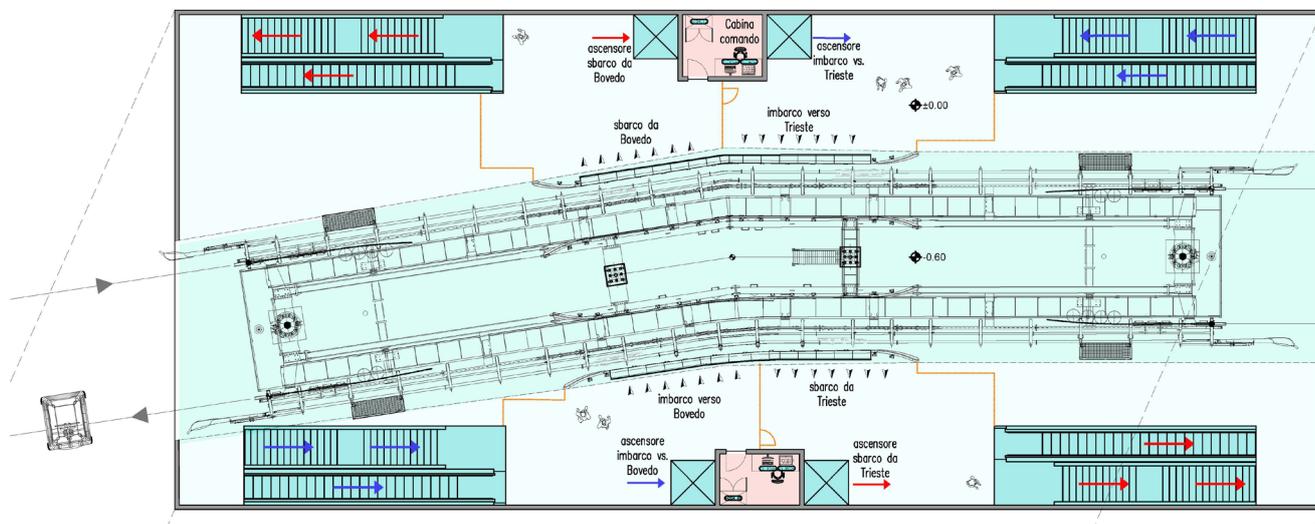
Planimetria piano primo stazione intermedia "Porto Vecchio".
